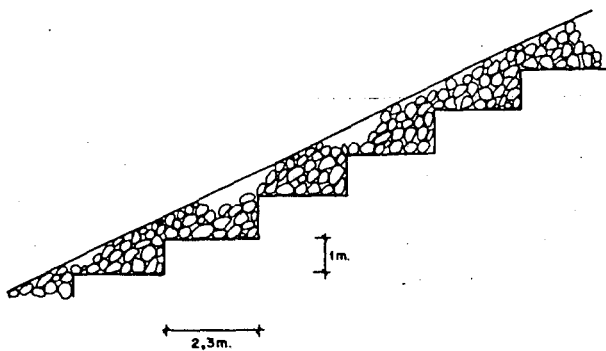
Contrafuertes de drenaje (Hackett, 1972).
